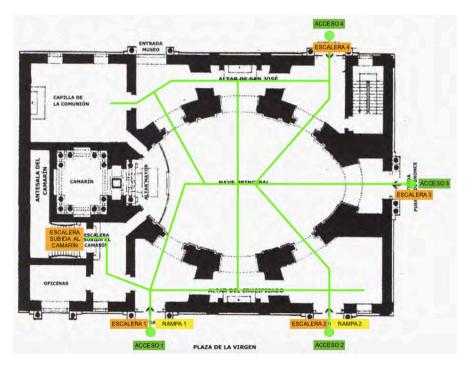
Sección de la planta de la Basílica indicando los accesos y recorridos (Fuente: www.jdiezarnal.com Plano modificado por el autor)
